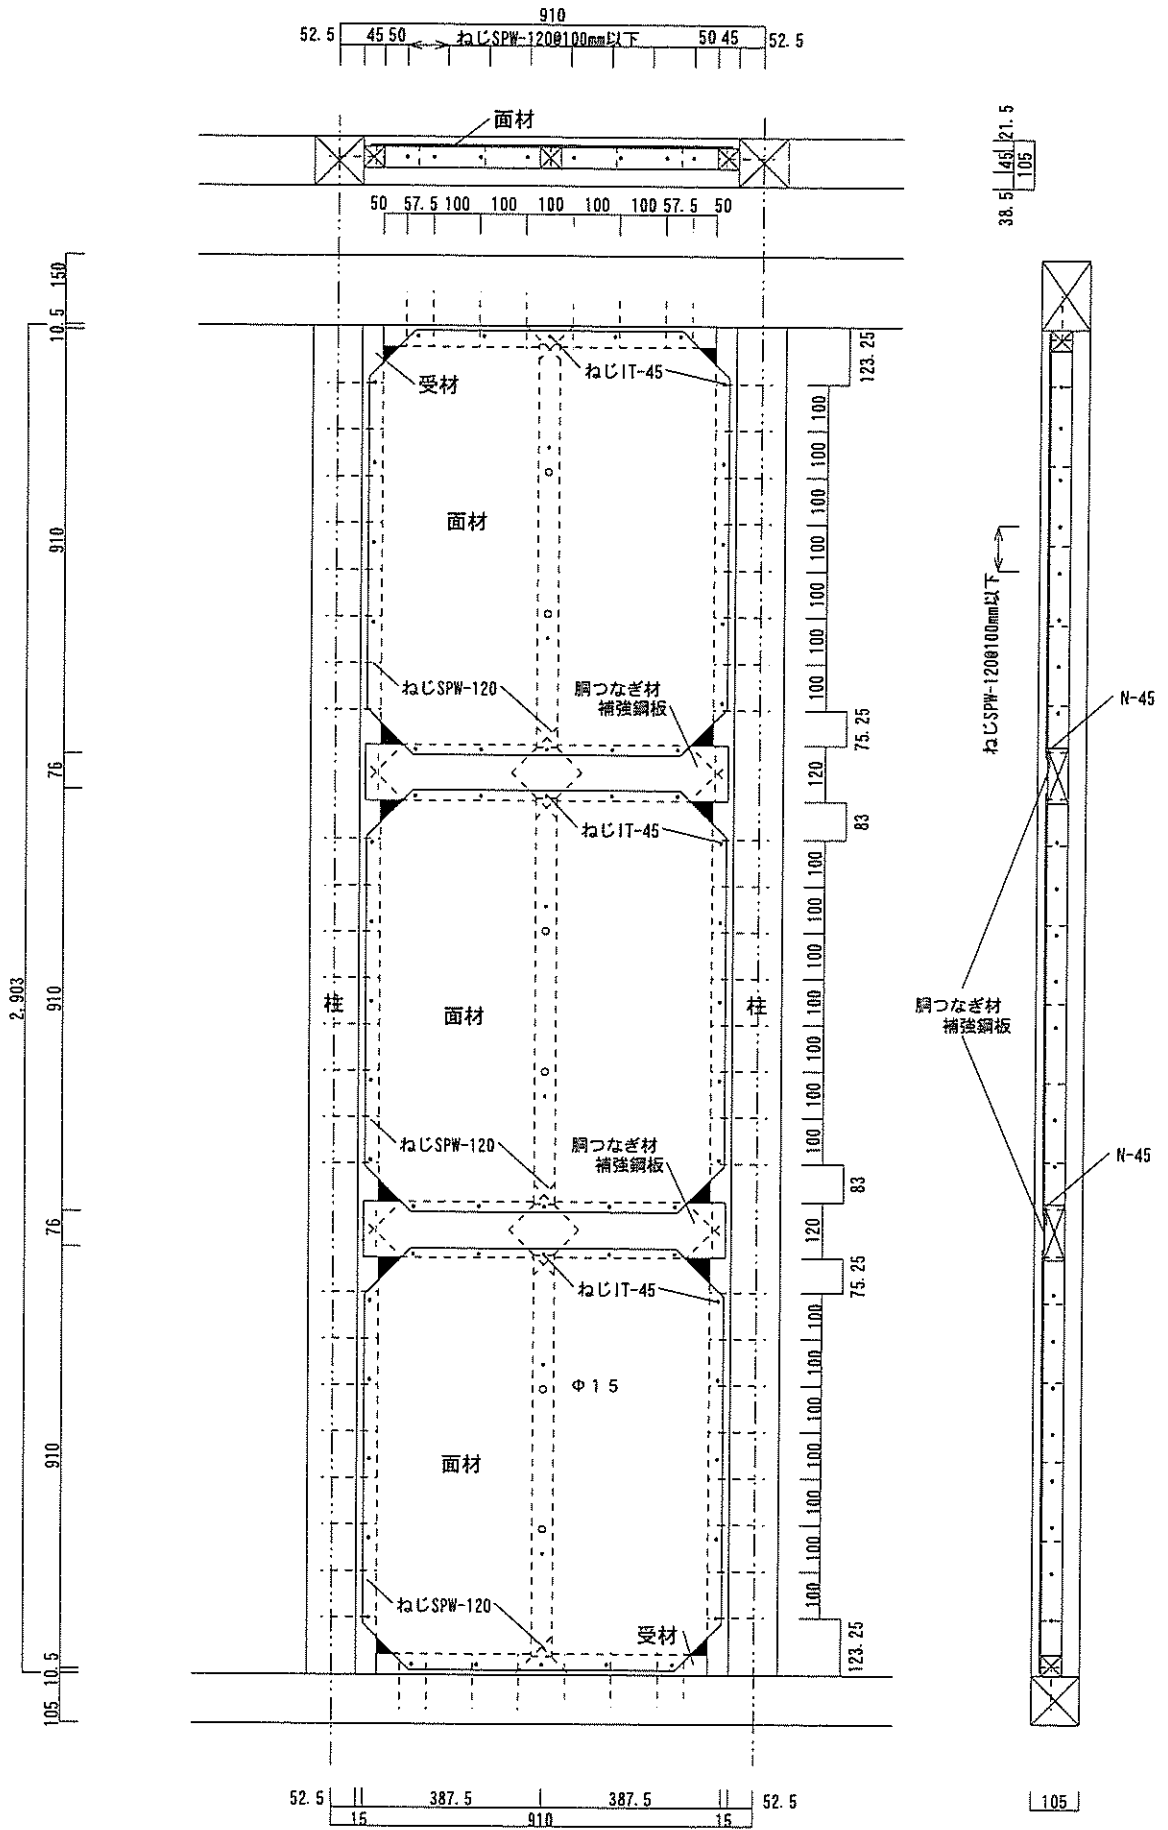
施工図 (柱寸法: 105×105mm、壁高さ最大時) (寸法単位: mm)
